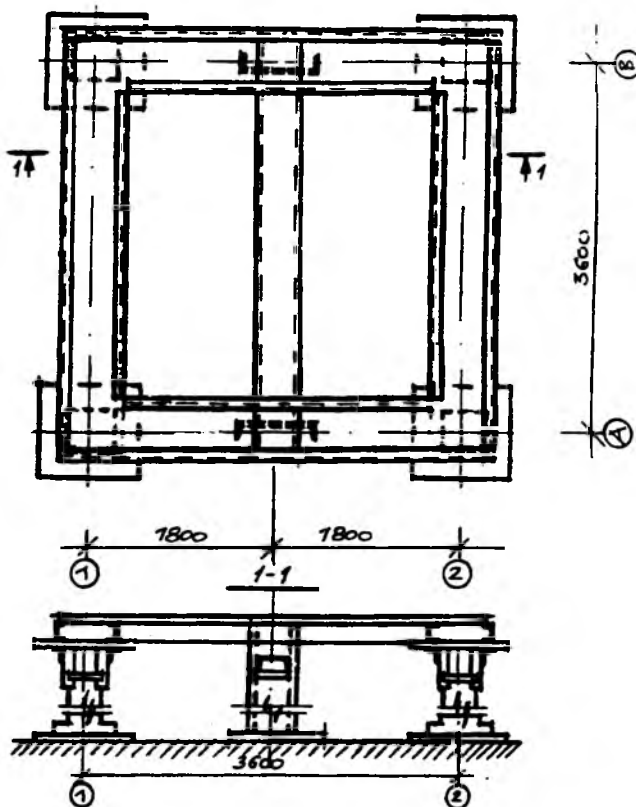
Стенд для монтажа и испытания фрагментов перекрытий
